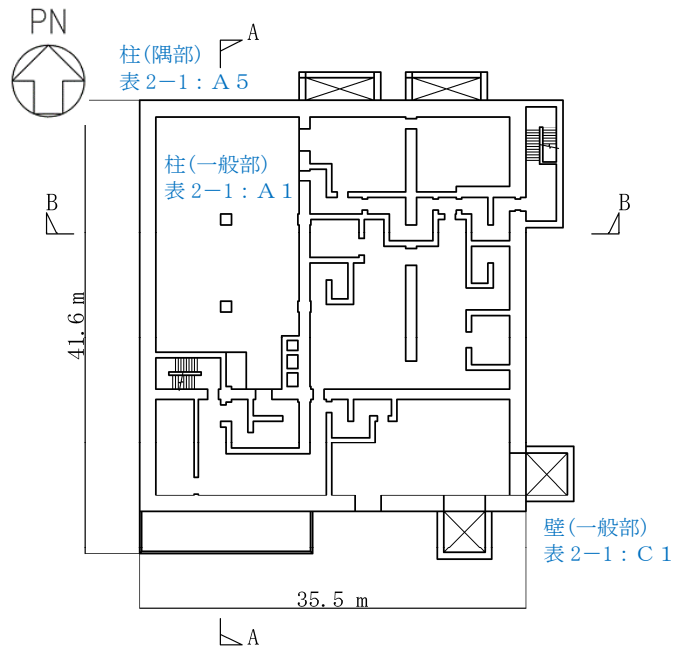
緊急時対策所建屋の概略平面図 (EL. 30.3 m)
